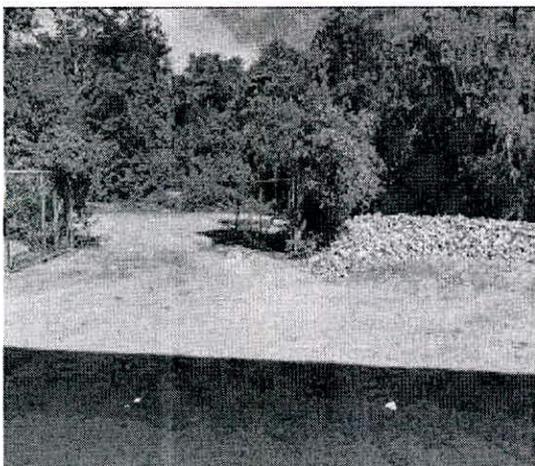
Visual perimetral a la la planta de trituración de la empresa MINERALES DEL SUR 2.
